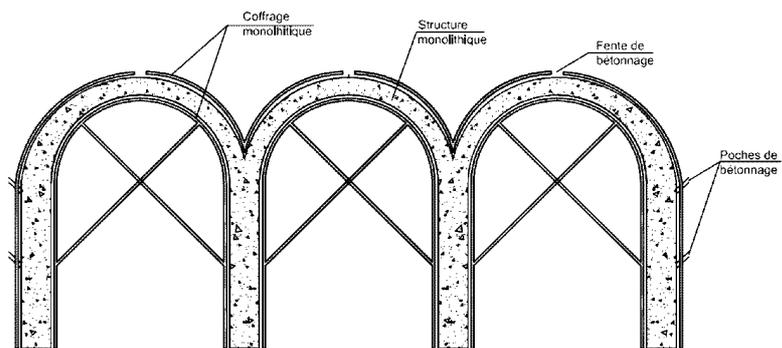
Coupe transversale du coffrage monolithique avec les fentes et les poches de bétonnage
